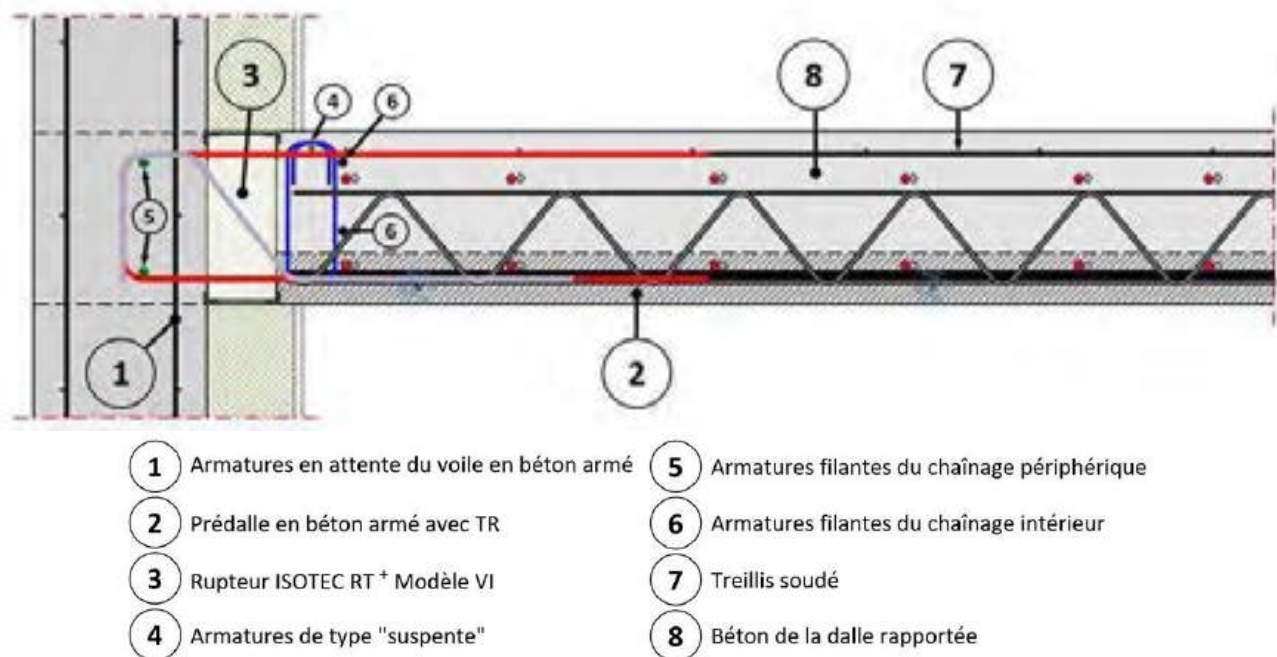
Coupe longitudinale d'une liaison voile-plancher ThermoPrédalle BA 0,2
